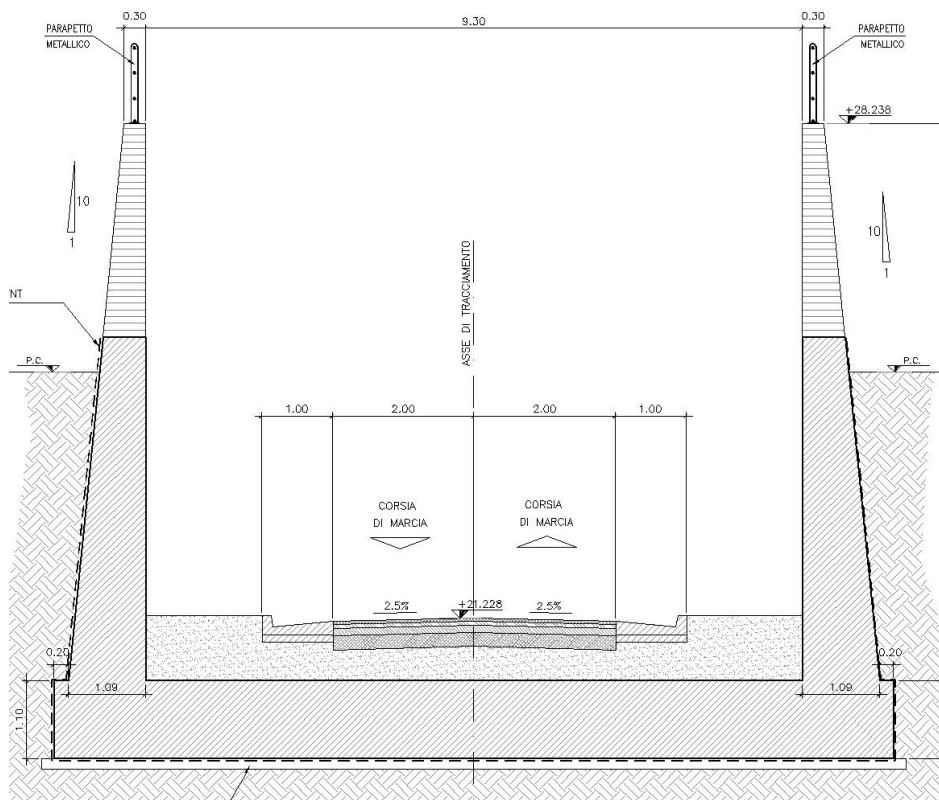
Muro di sbocco/imbocco - Sezione trasversale
